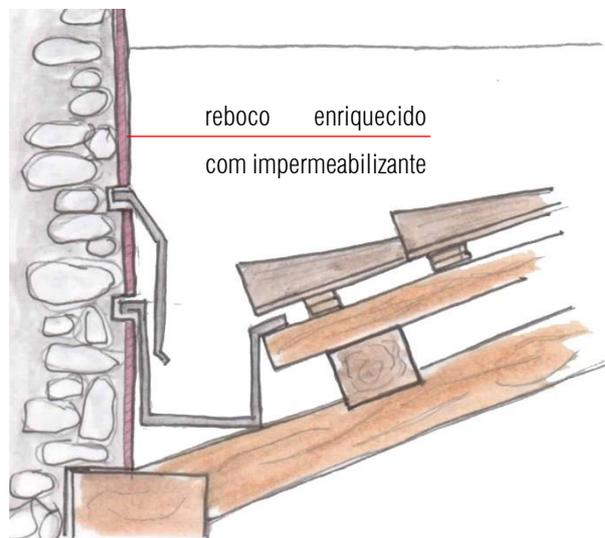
Impermeabilização da parede que recebe a instalação de calhas
